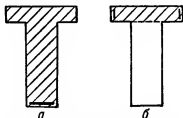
Сечения, условно принимаемые при расчете подкрановых балок:
